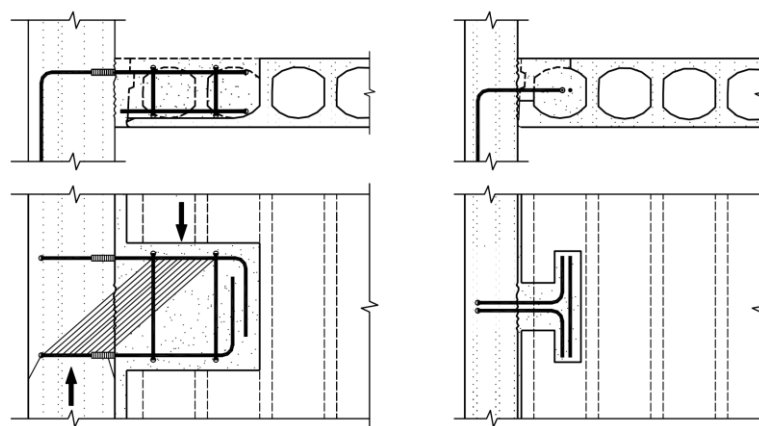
Pormenores de ligações longitudinais de uma laje alveolar a uma parede estrutural com cintas perimetrais [10]
